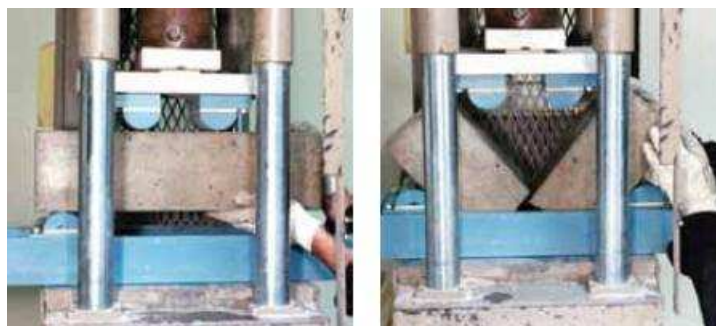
Esquema de un aparato para el ensayo a flexión
